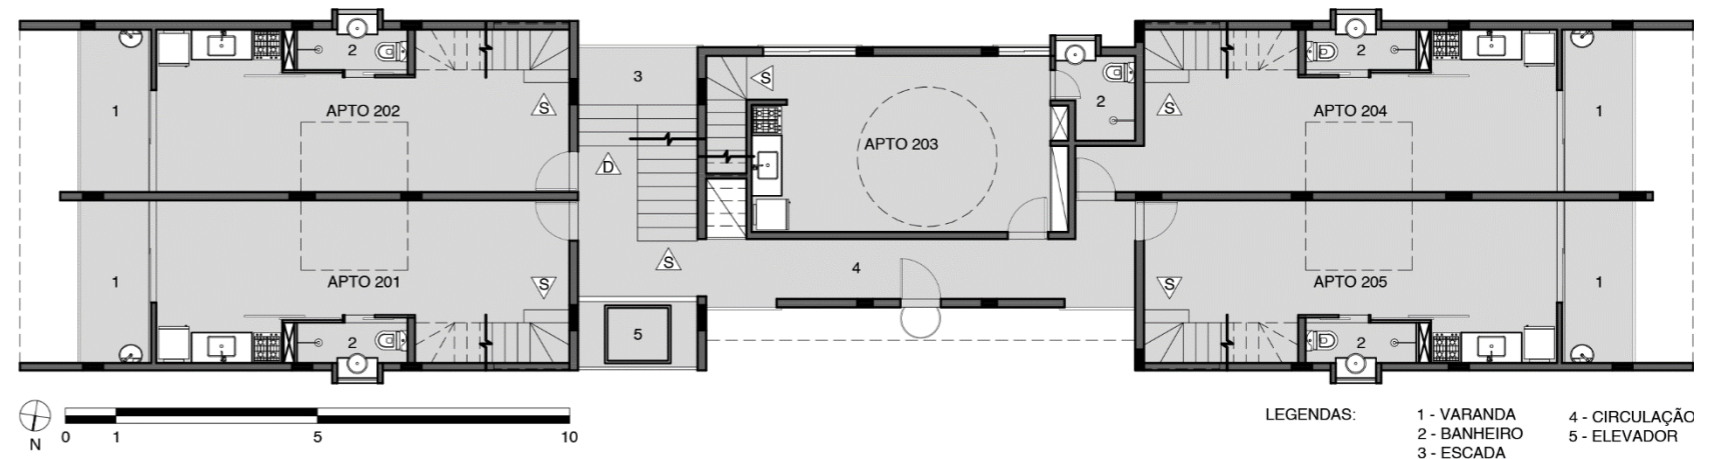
Planta do terceiro pavimento dos Estúdios Capelinha
